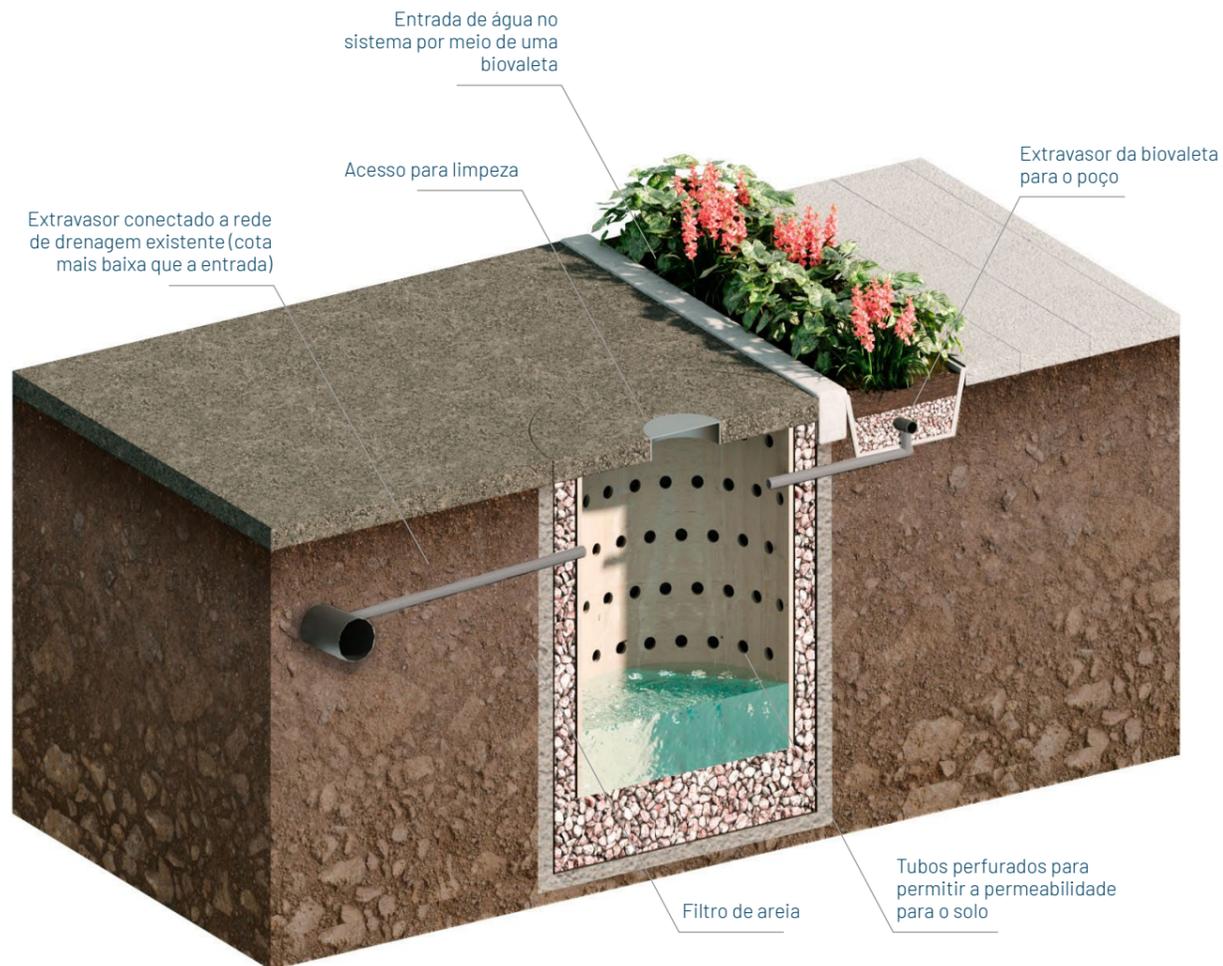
Poço de infiltração (Fonte: Guajava, 2023).
